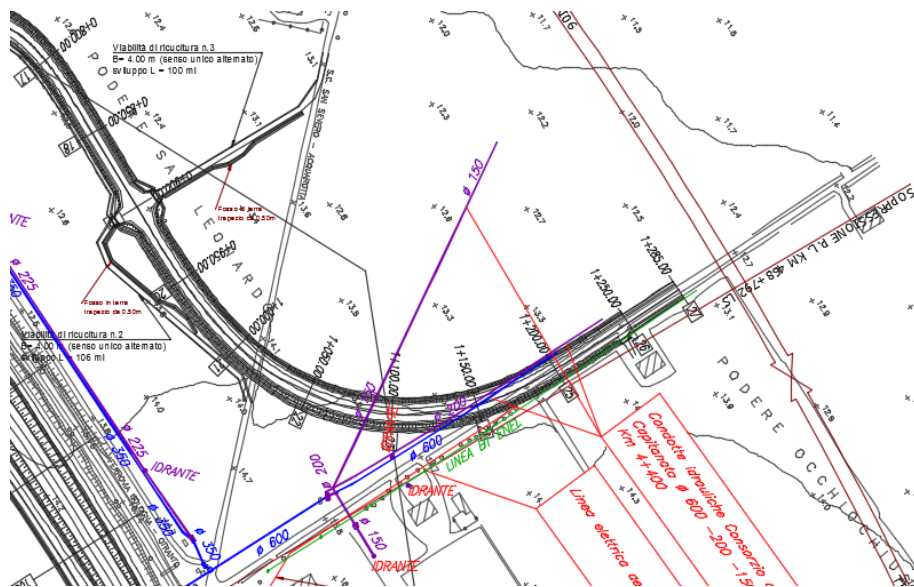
Stralcio planimetrico con individuazione dell'interferenza al km 4+400 (φ150-200-600).
